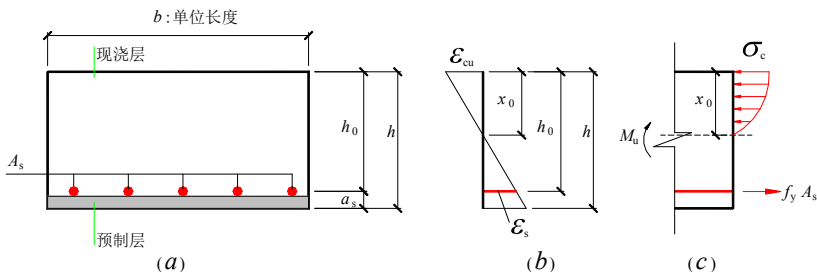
单筋矩形截面（叠合楼板）的计算简图
